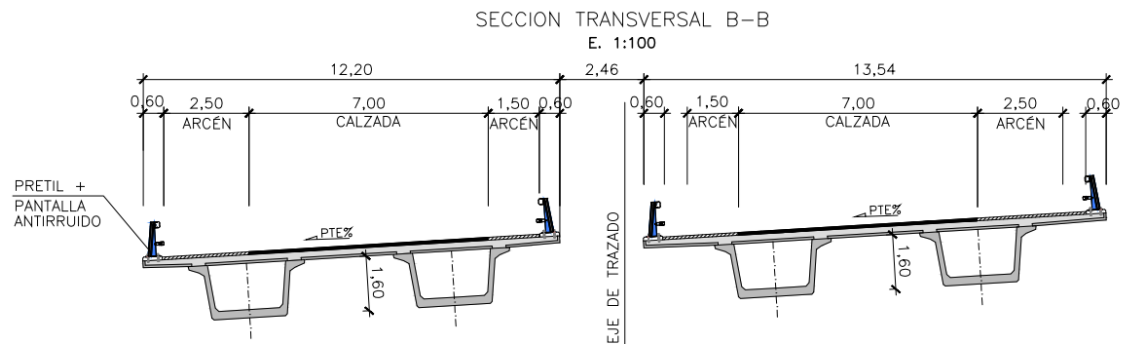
Sección tipo Viaducto de Gútar (en vano 8)
